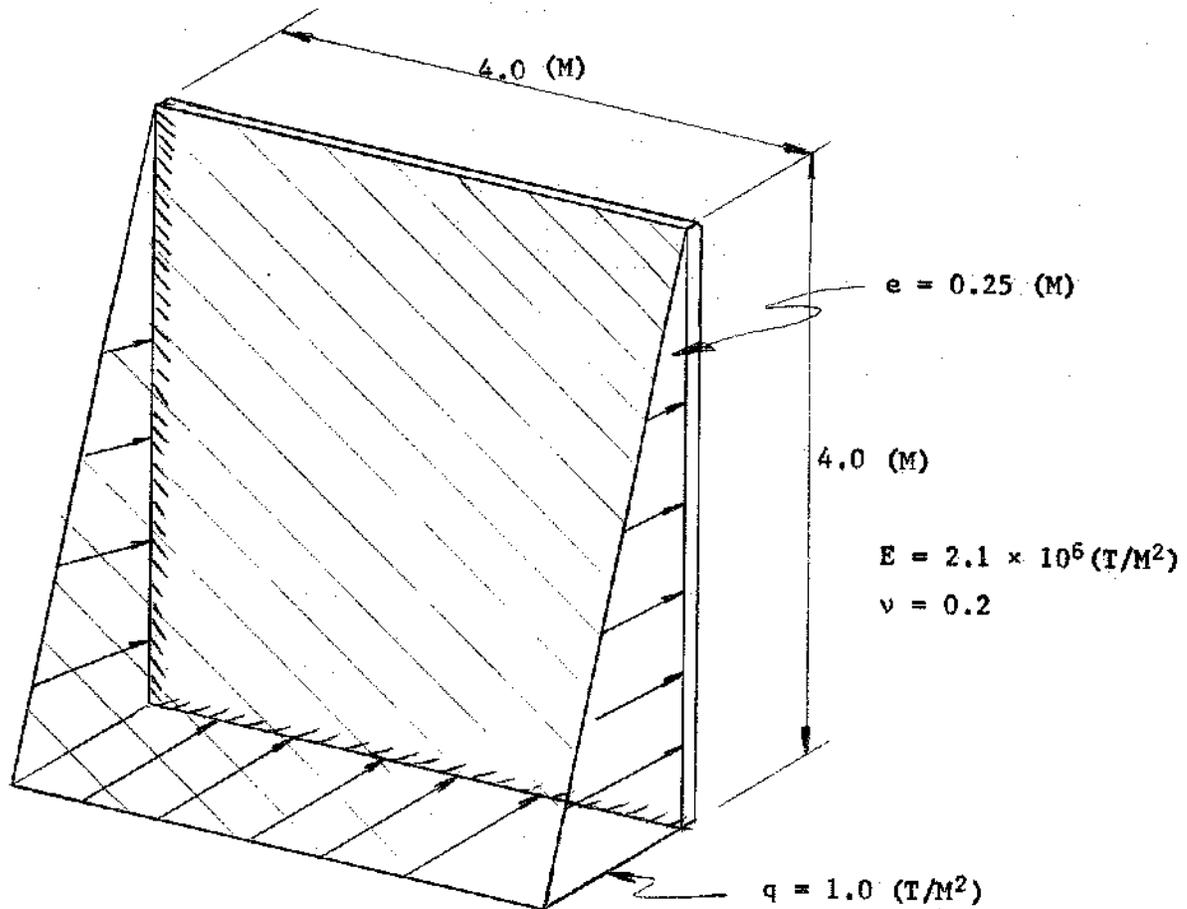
MURO DE UN ESTRIBO DE PUENTE CARRETERO SOMETIDO A EMPUJE DE TIERRA.
